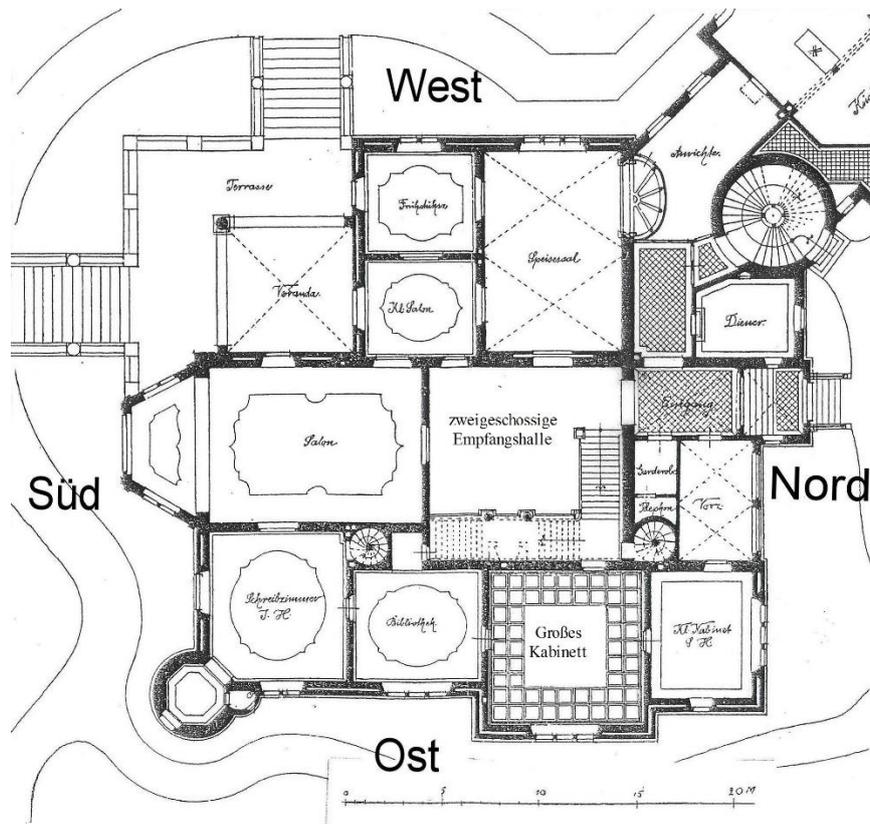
Schloss Wiligrad, Herrschaftsflügel, Grundriss entstanden nach dem Edwin-Oppler-schen-Entwurfsprinzip für das „Bauen von innen nach außen“; Zeichnung Albrecht Haupt 1903
